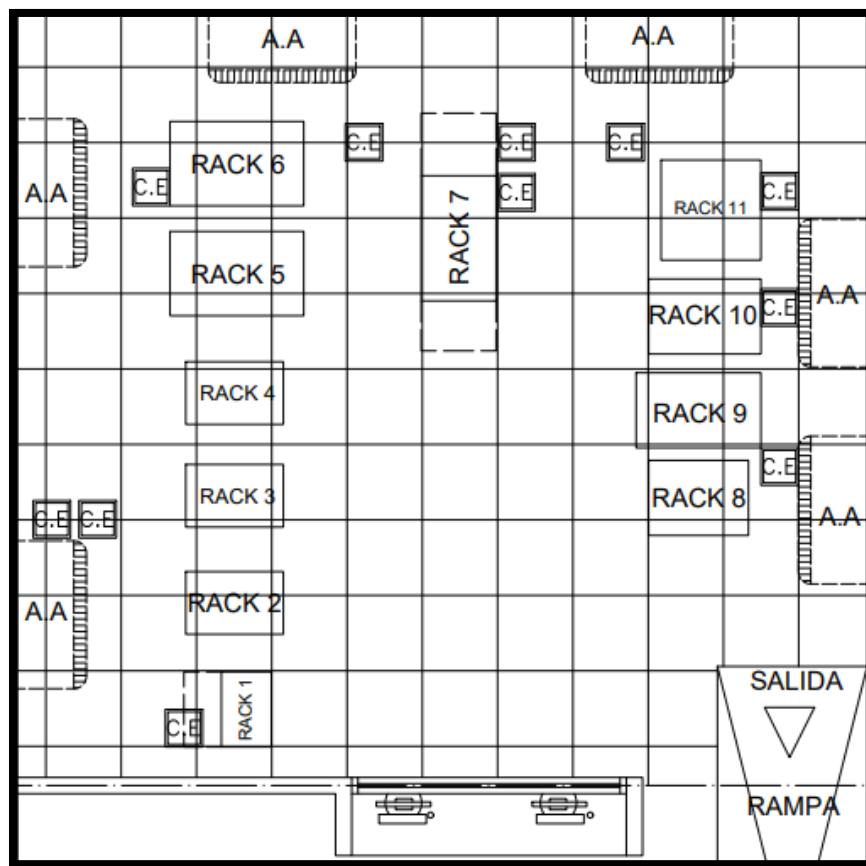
Plano distribución de Centro de Datos REDTELCOM. (Elaboración Propia)
